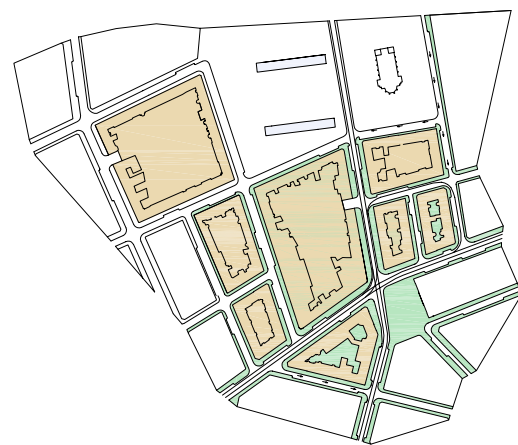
Grüner Geschoßwohnbau mit zahlreichen Terrassen
